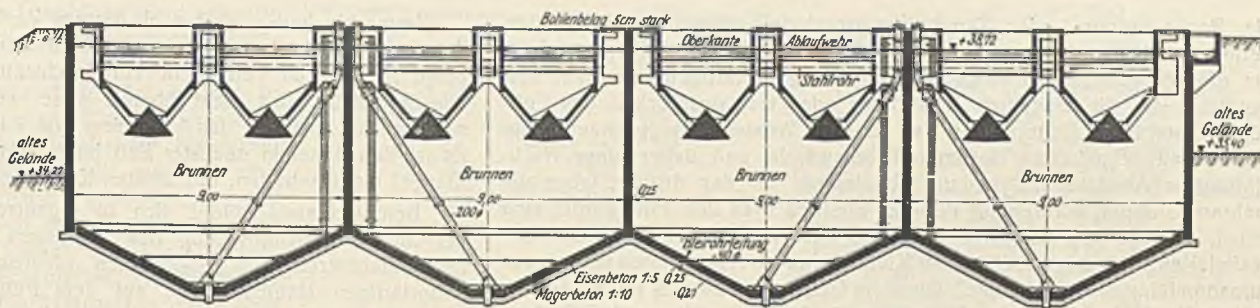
Emscherbrunnenanlage auf Kläranlage Berlin-Wansdorf. Schnitt.
